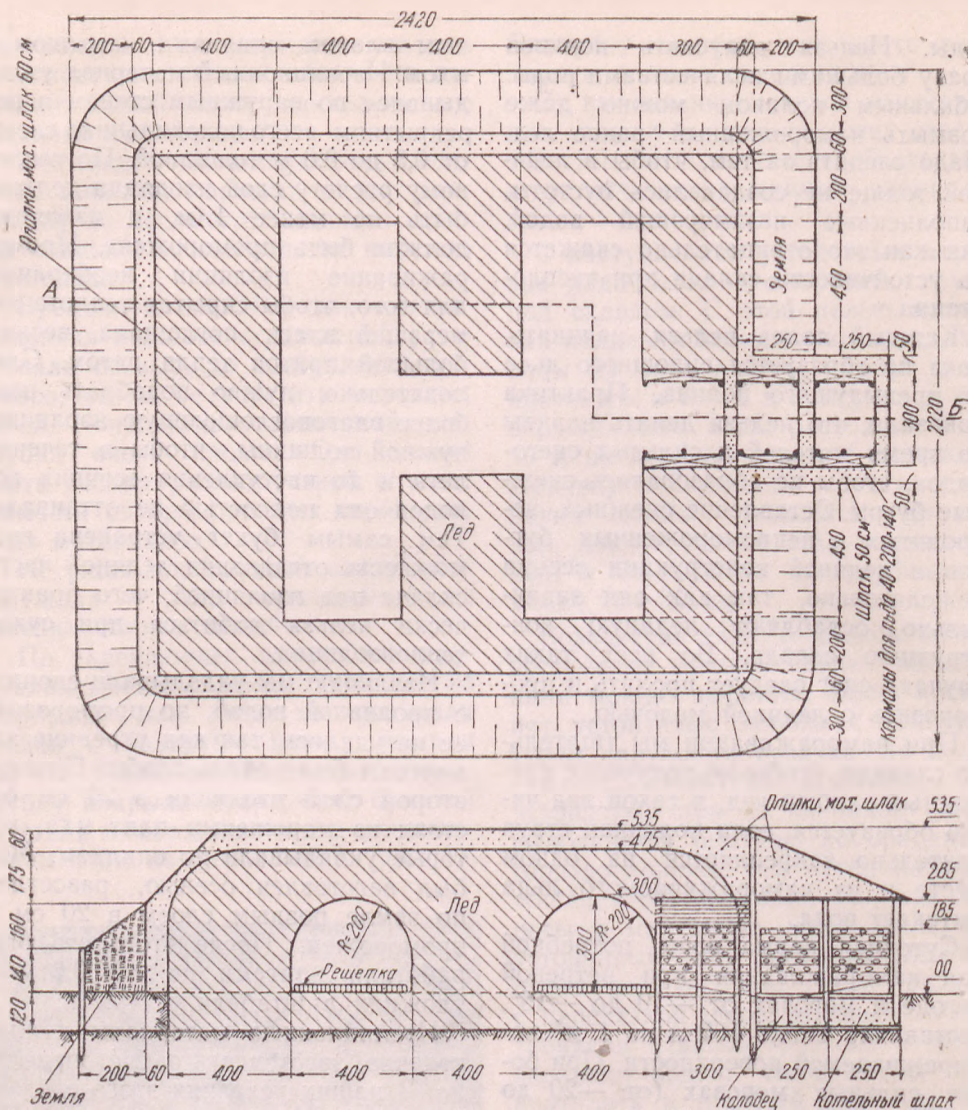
План ледяного склада в Ручьях и схема его термоизоляционного укрытия:
